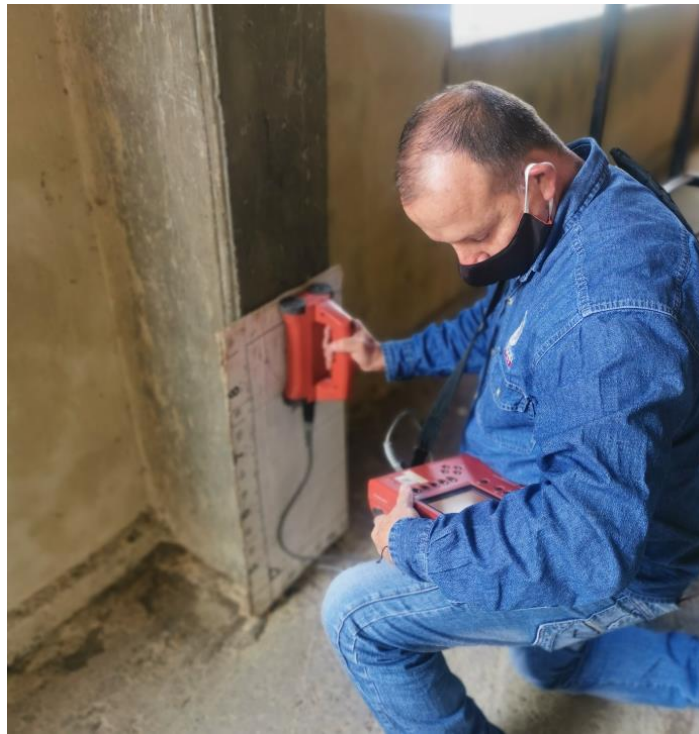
Escáner de refuerzo horizontal inferior – Columna 1 (cara lateral)
